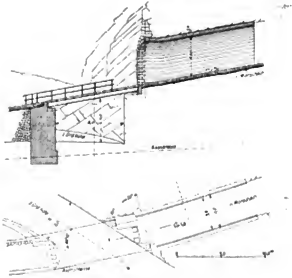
Tunnelzugang bei Km. 0,09. — 1:400.
